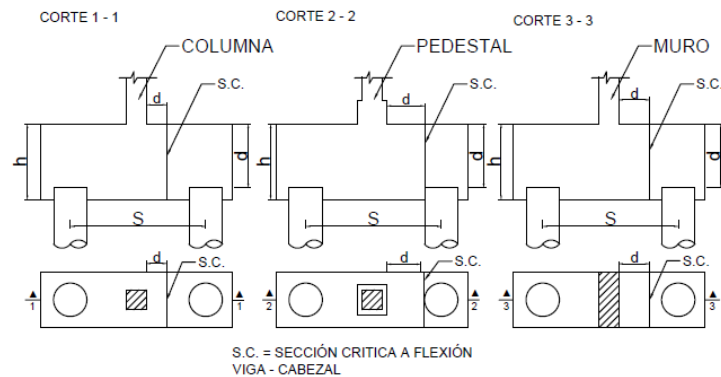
Esfuerzos cortantes en la columna, pedestal o muro de concreto.
